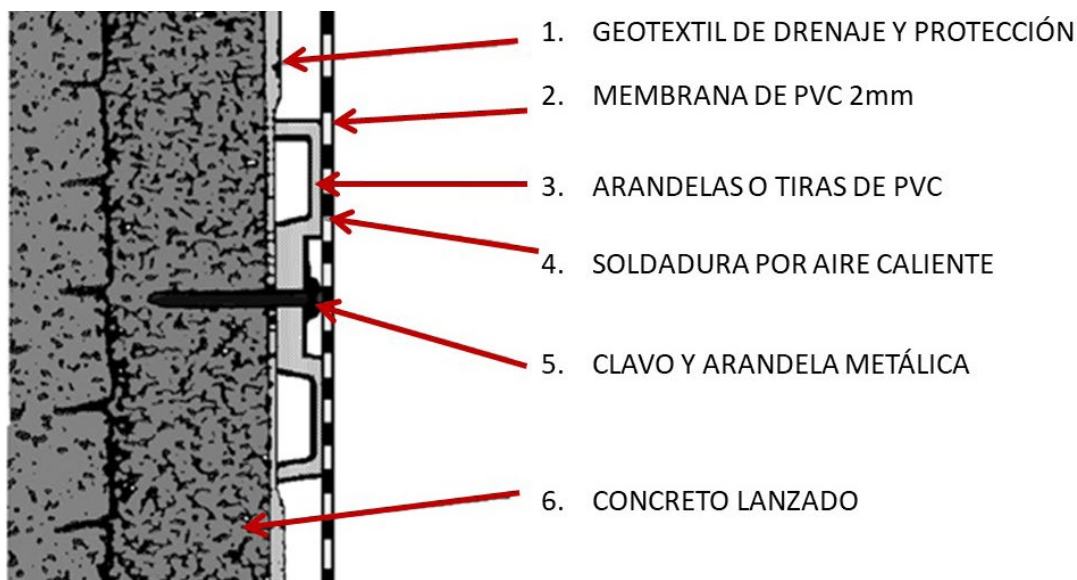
Anclaje del geotextil y soldadura de la membrana
